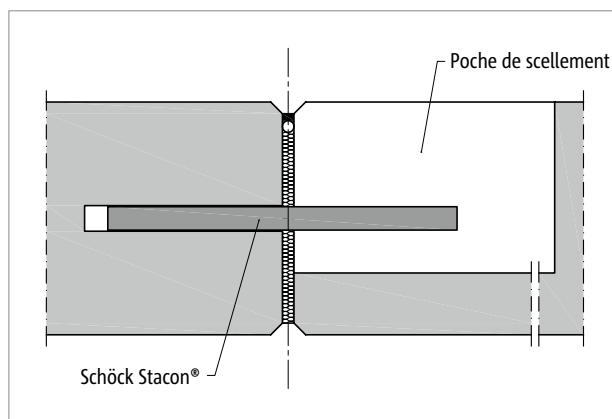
Schöck Stacon® : Formation de joints de dilatation - balcon préfabriqué
